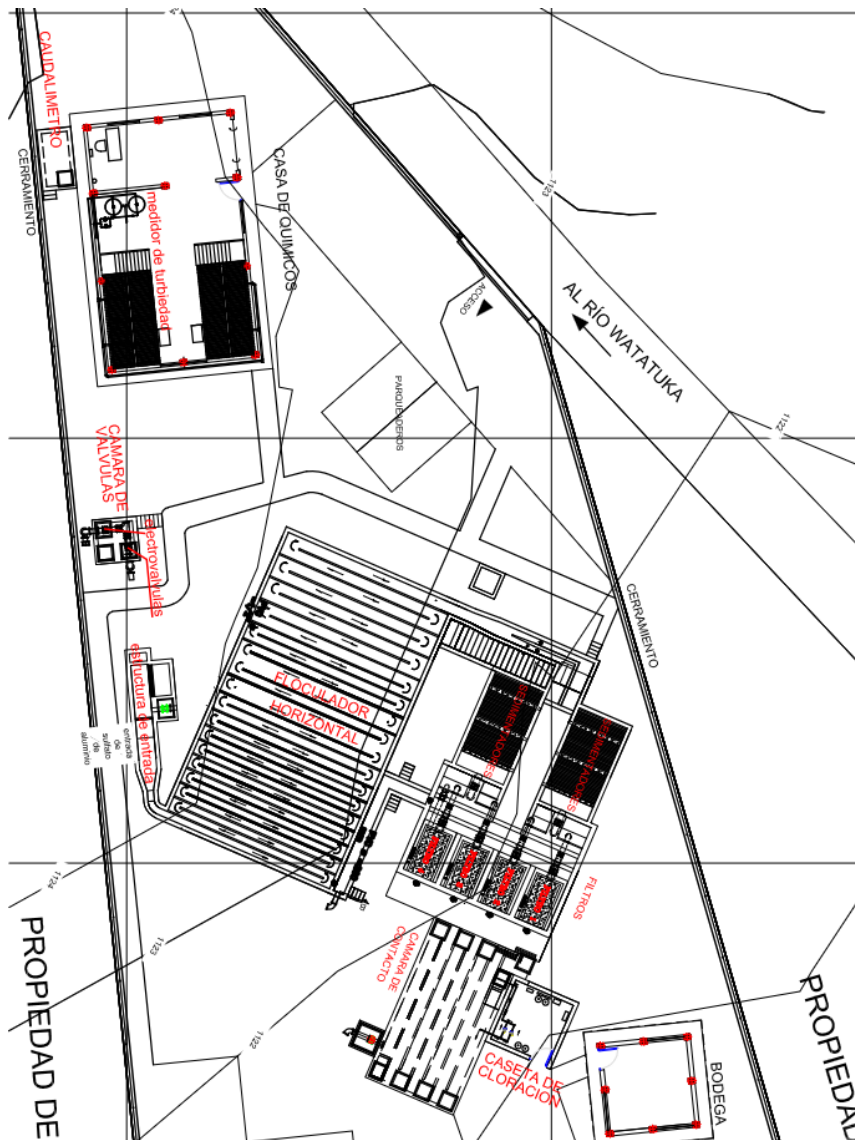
Planta de tratamiento Plano – (Jorge Poveda A, 2020)
